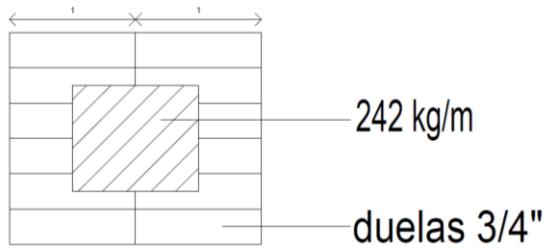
y 3. Detalle donde se colocará la viga V_1 y planta arquitectónica delimitada para su análisis.
